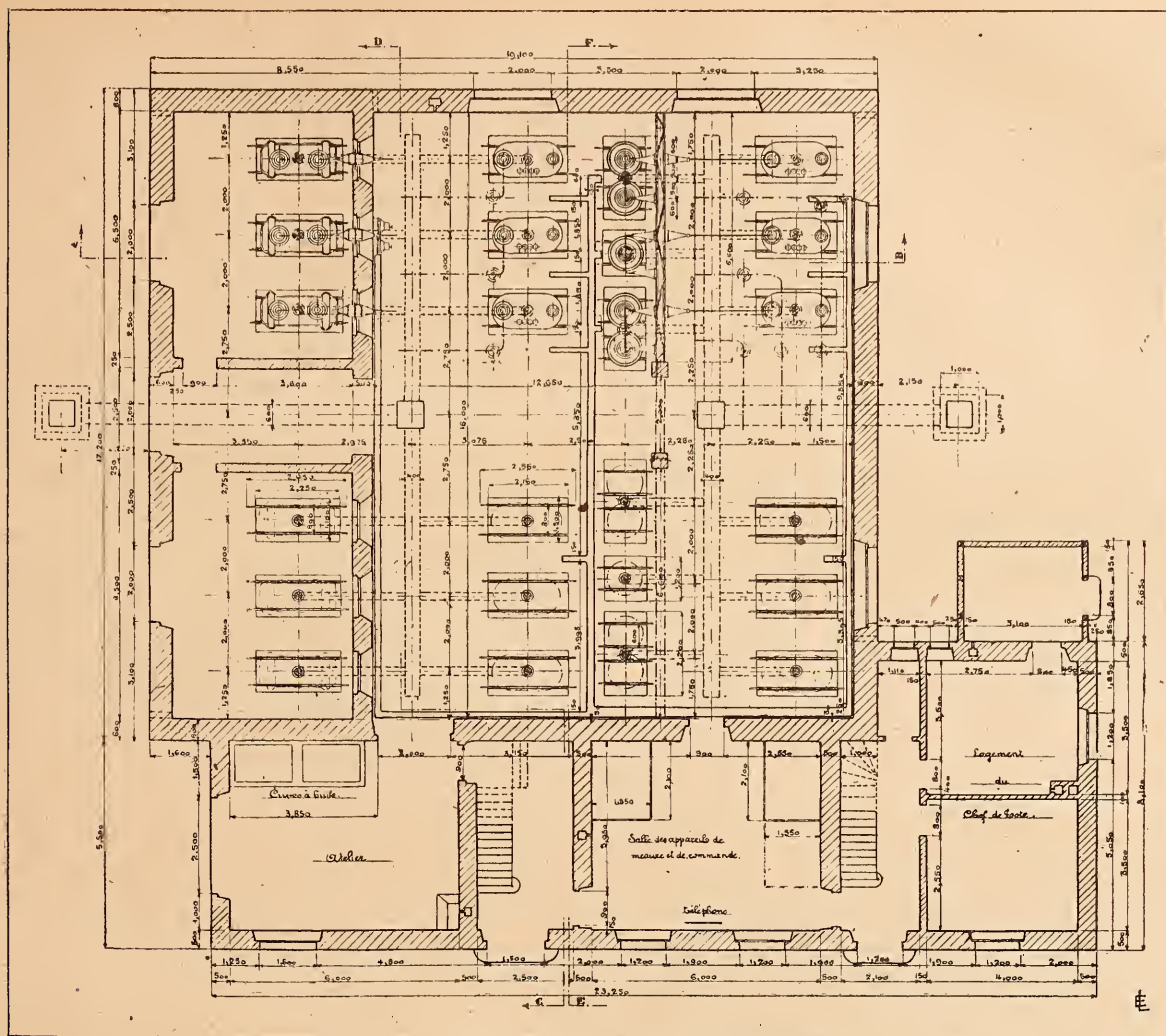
Plan du poste de Delle (rez-de-chaussée).
